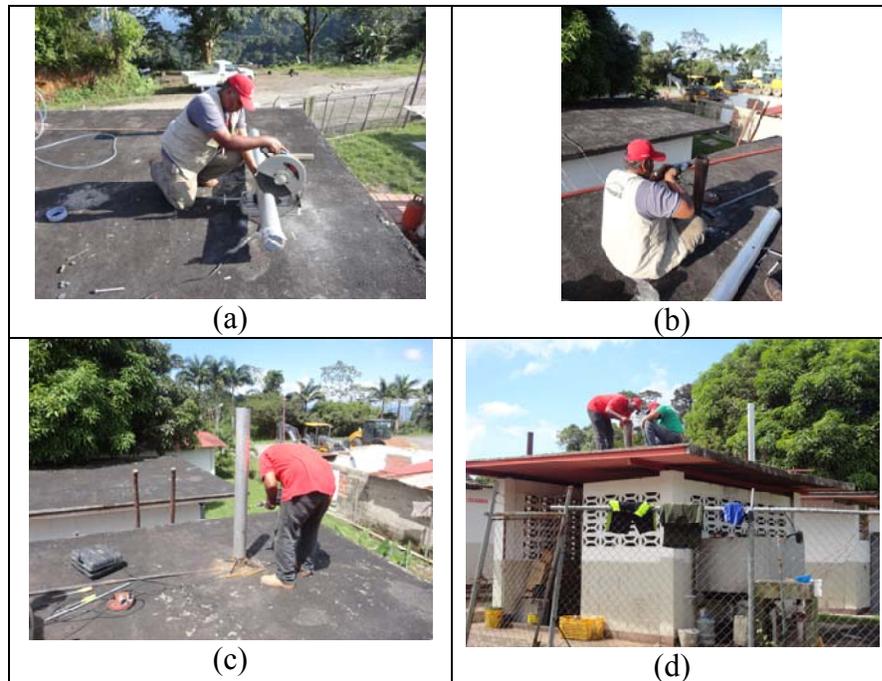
(a) Corte de tubo, (b) Perforación de mástil, (c) Fijación de tubo mástil en el anclaje, (c) Vista de tubo mástil anclado.
